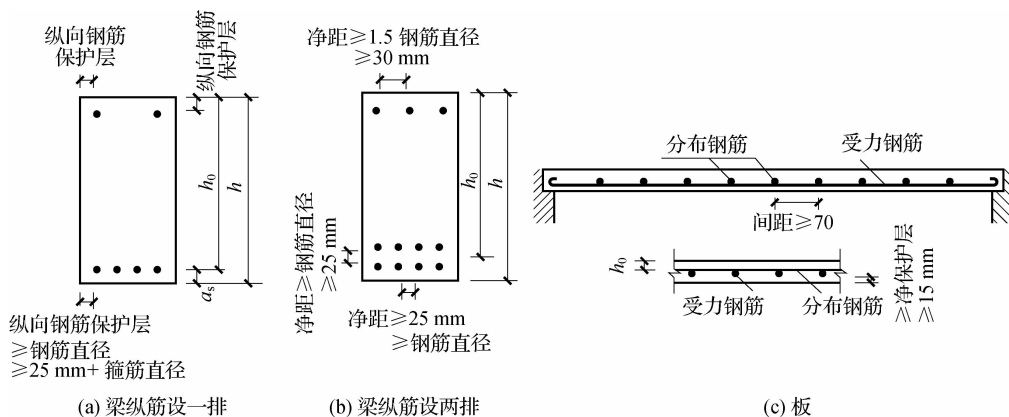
梁、板纵向受力钢筋的间距及有效高度
